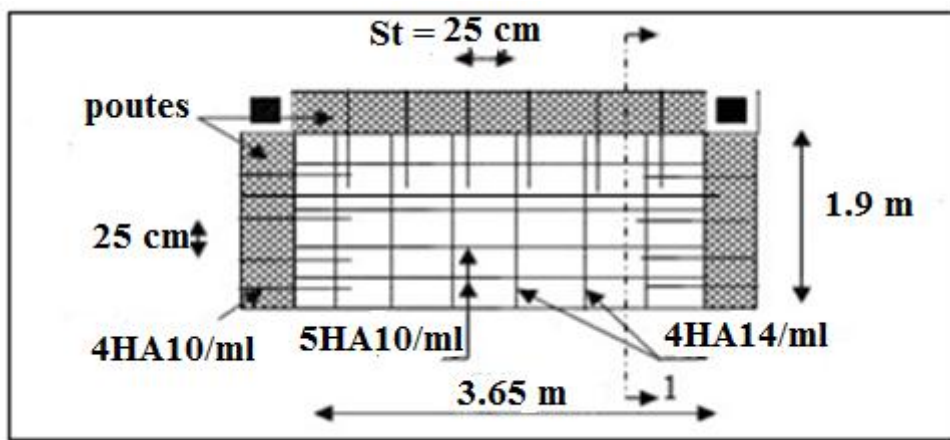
Schéma de ferrailage de la dalle sur 3 appuis.
